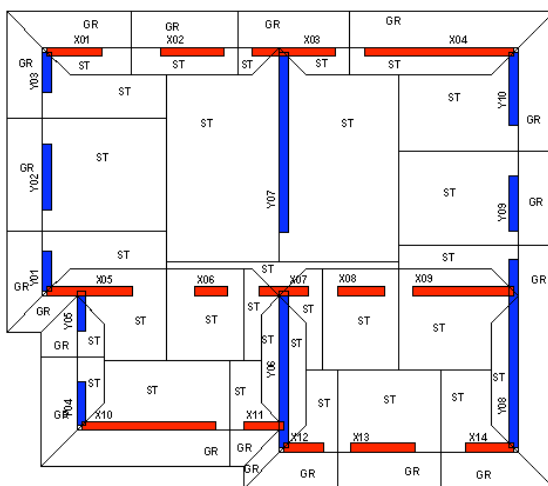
Pianta piano primo – Aree di solaio gravanti sui maschi murari del piano terra
